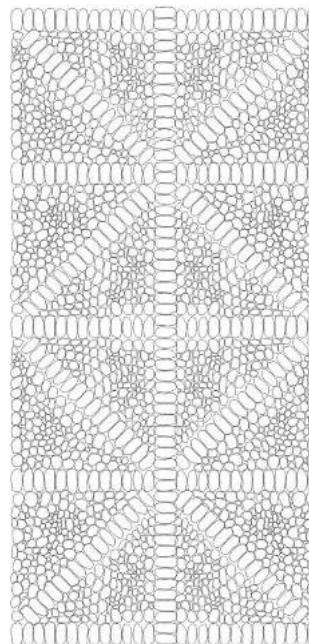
Patrón en base a piedras de río presente en los pavimentos de las antiguas calzadas de Barraza.
